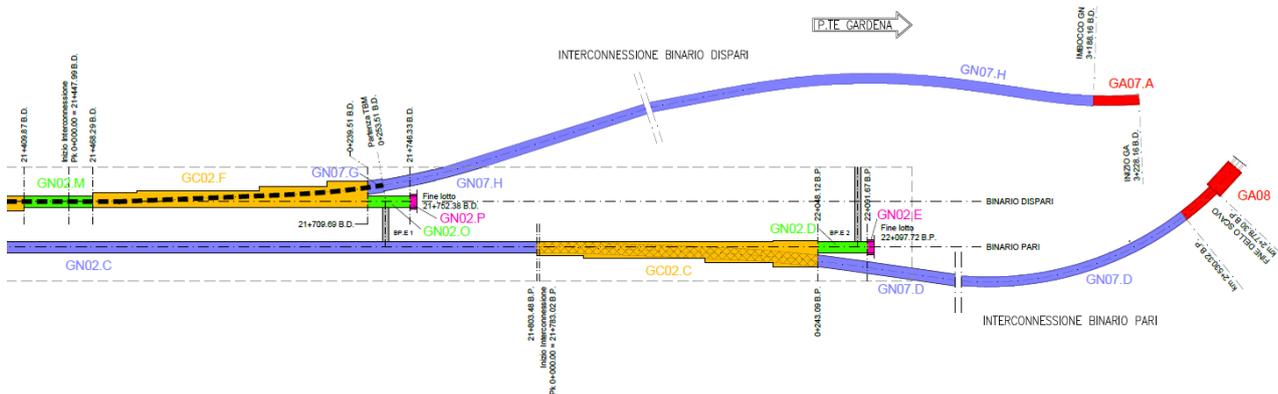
Schema WBS Tratto d' Opera Imbocchi Stazione Ponte Gardena
